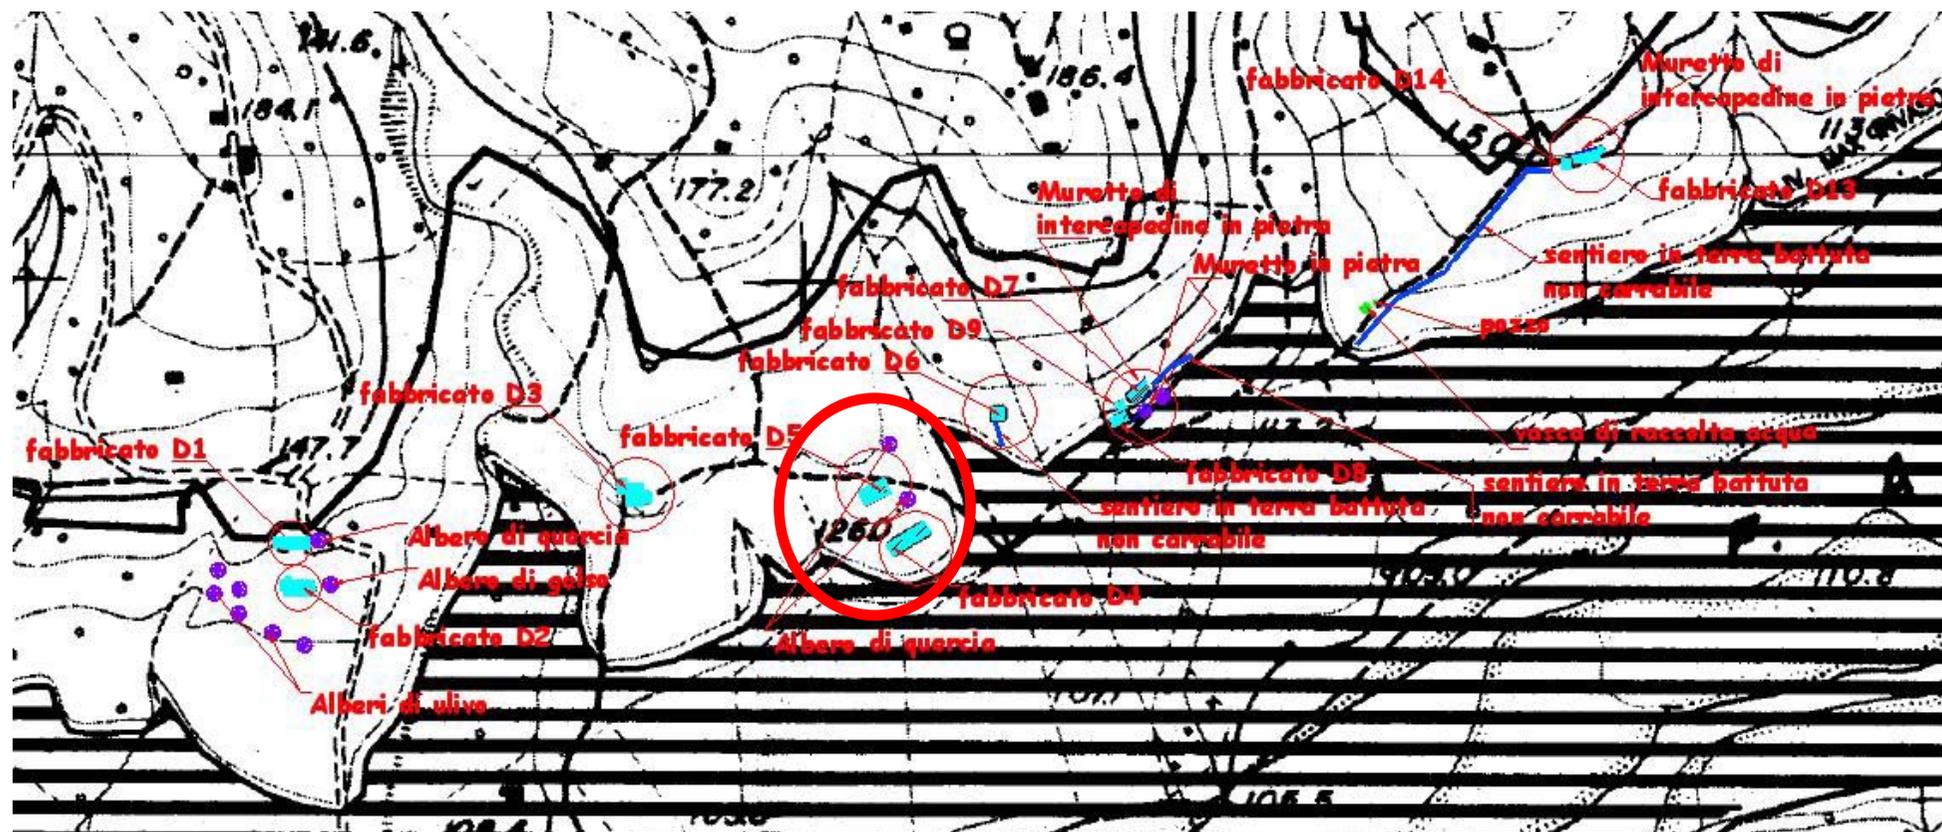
Planimetria con individuazione degli edifici caso-studio (fabbricati “D4” e “D5”).
